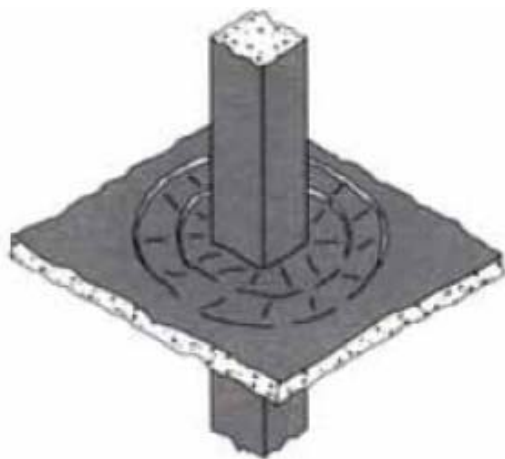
Esquema da fendilhação numa laje de betão armado sujeita a punçoamento [27]
